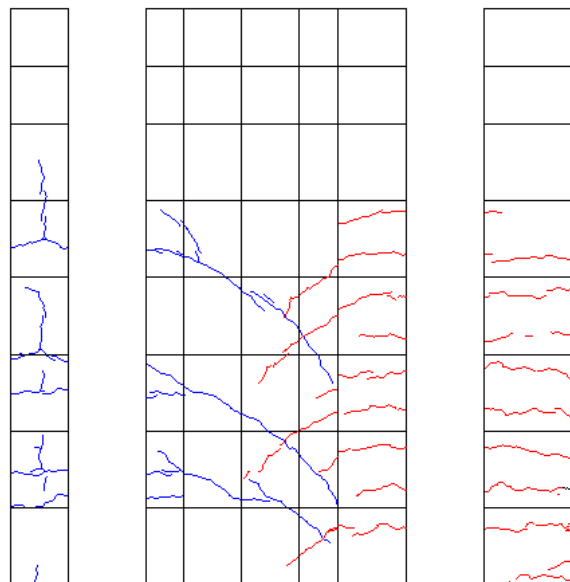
R=1/200 ひび割れ図
